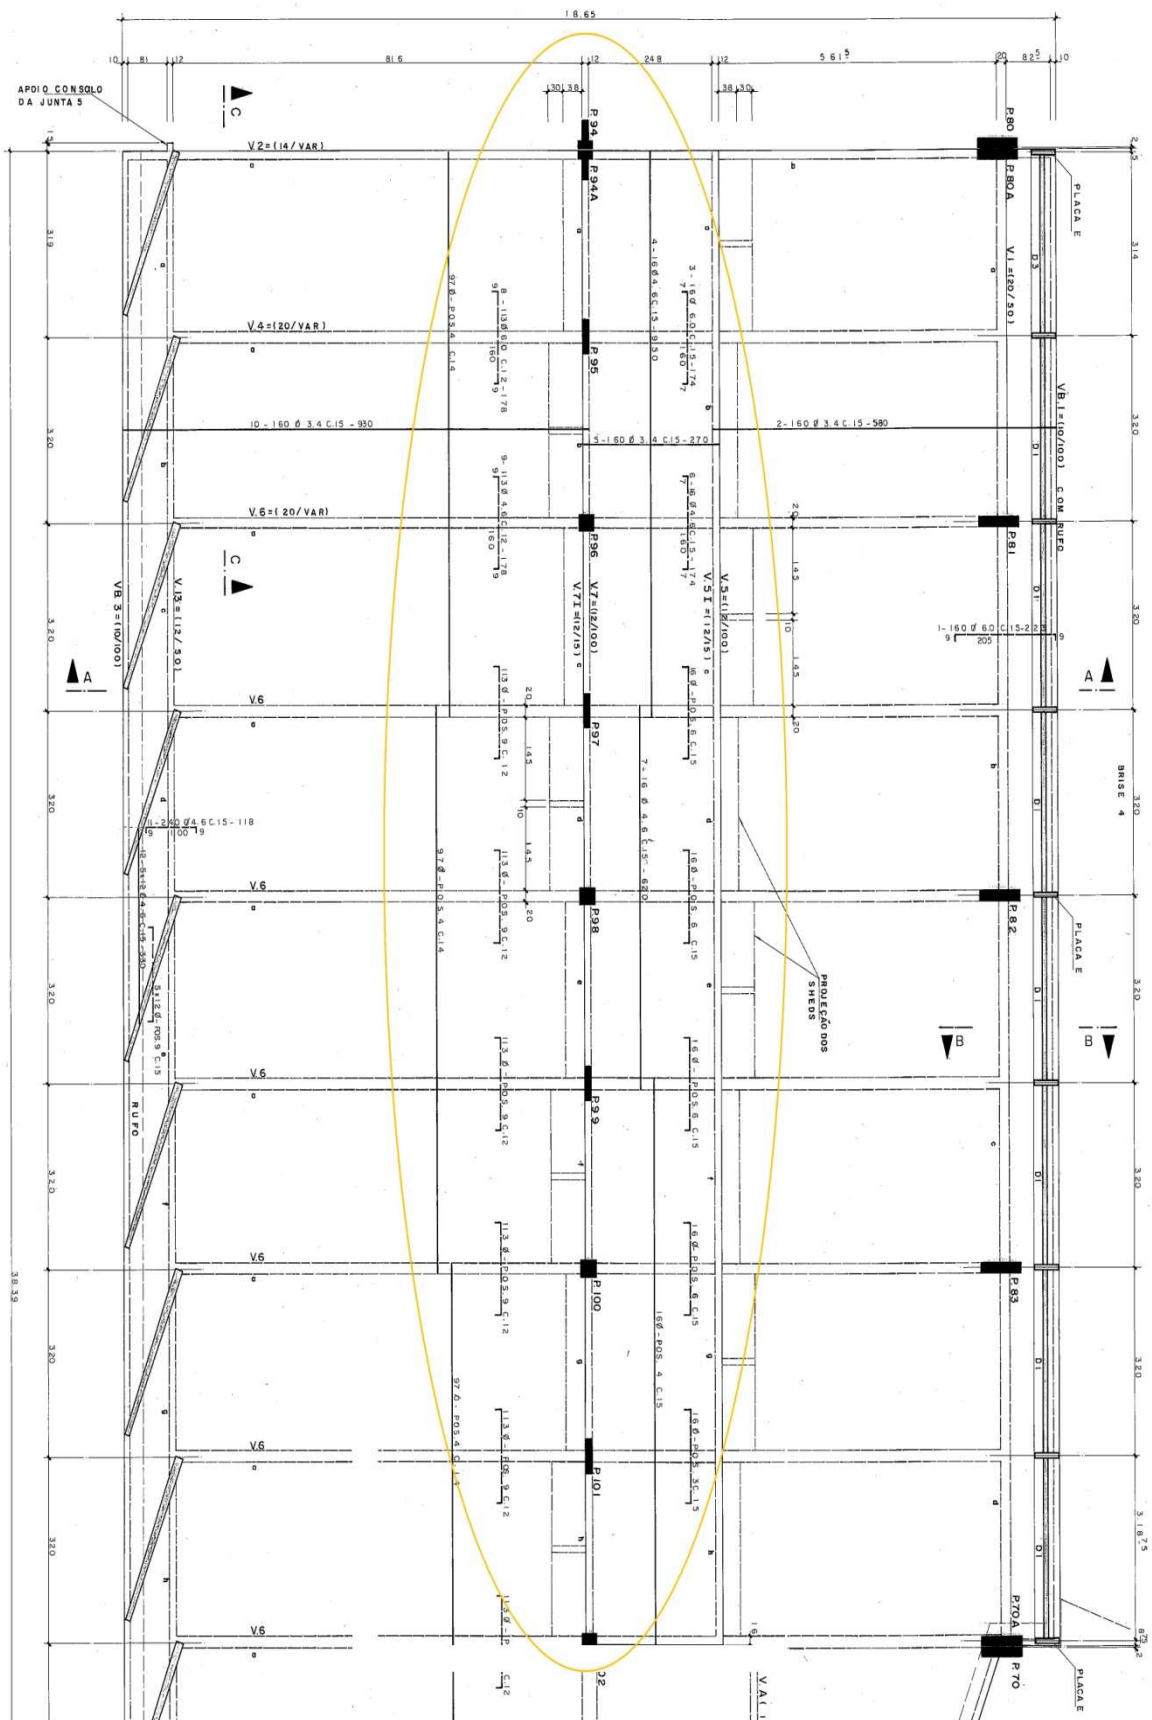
Visualização da Planta de Forma e detalhes da Cobertura da FA (CEPLAN - UnB, 2008).
